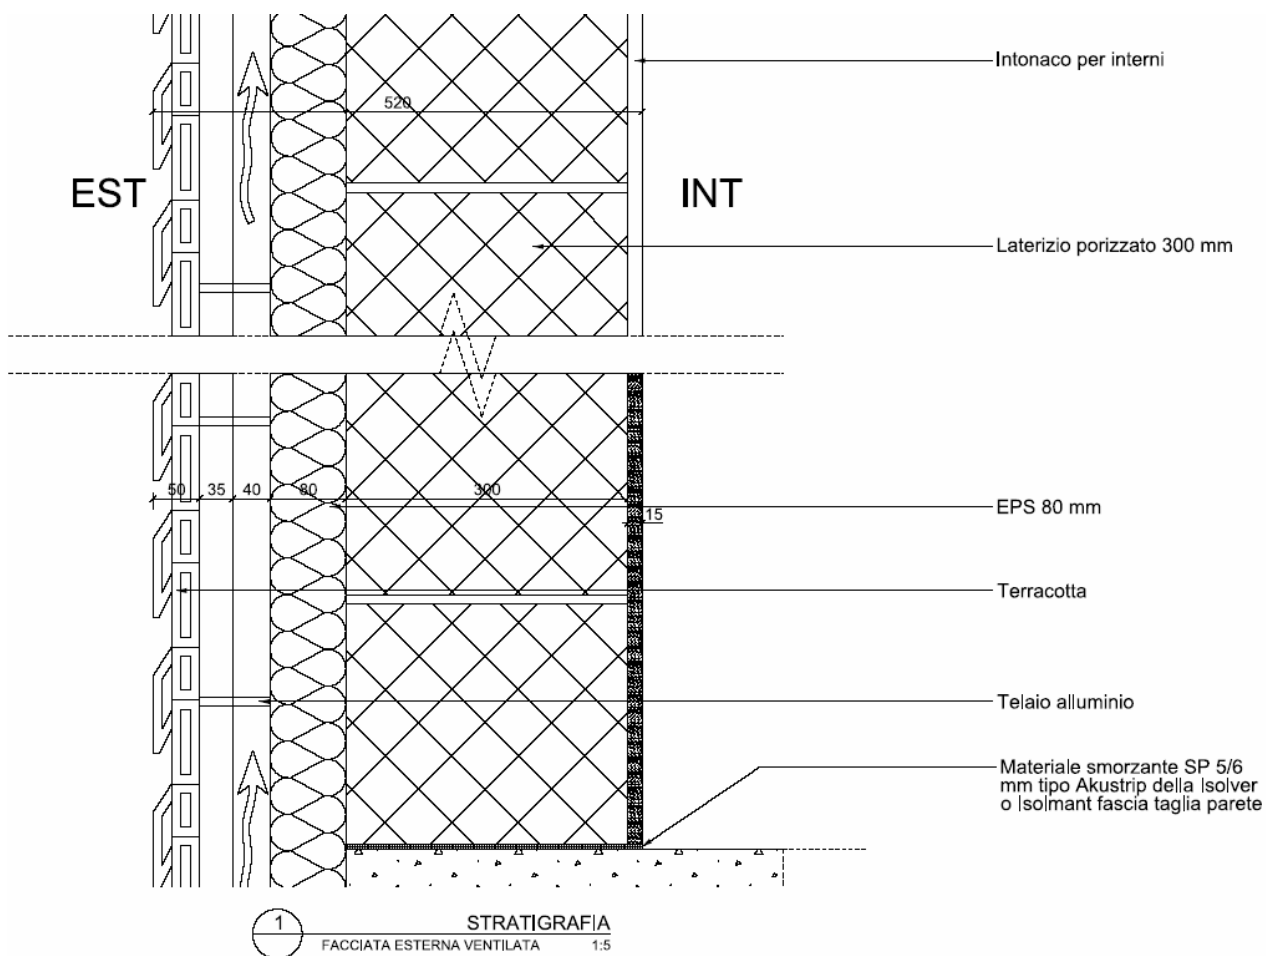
Sezione verticale della parete di facciata esterna ventilata
